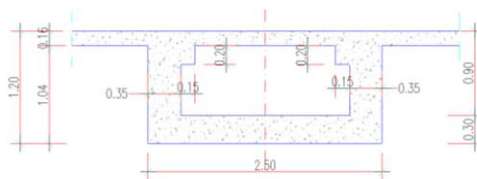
Secção da viga transversal, ao longo do vão.
